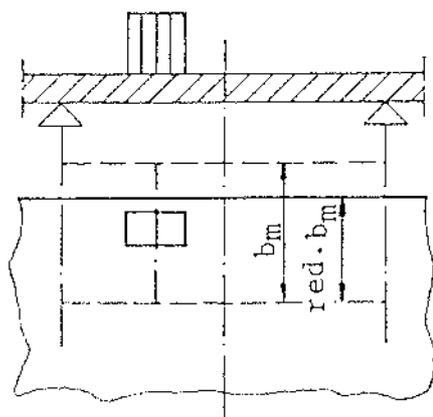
Ancho colaborante reducido de cargas cercanas al borde.
